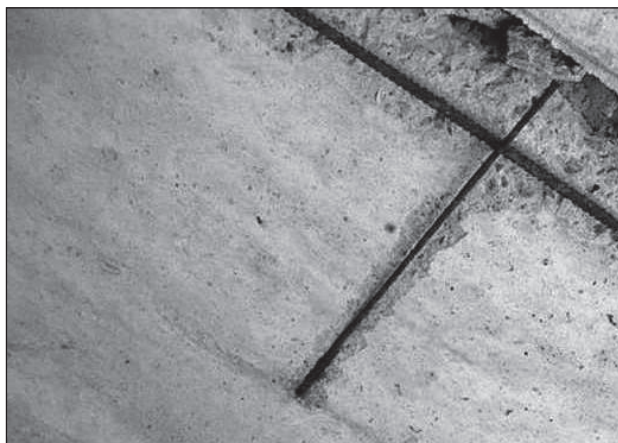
Оголення арматури плит перекриття сходової клітини
